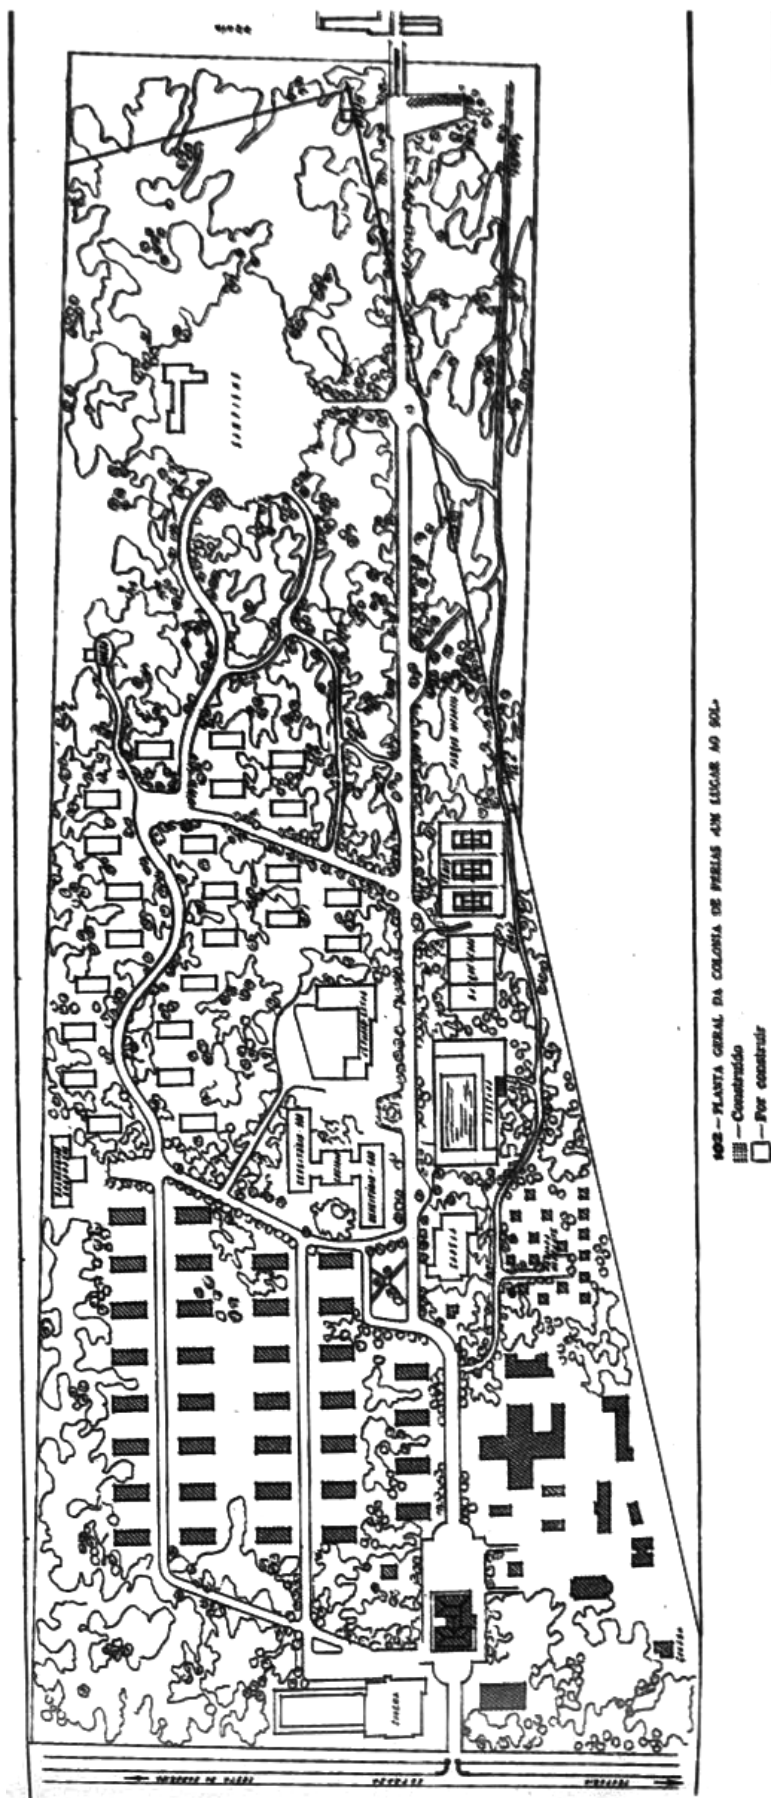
| Planta geral da Colônia de Férias "Um Lugar ao Sol", com a indicação dos volumes já construídos e volumes por construir.
